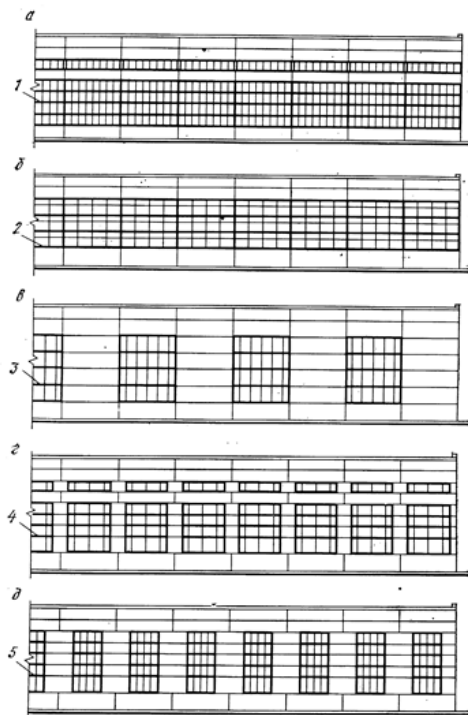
Варианты разрезки стен производственных зданий:
